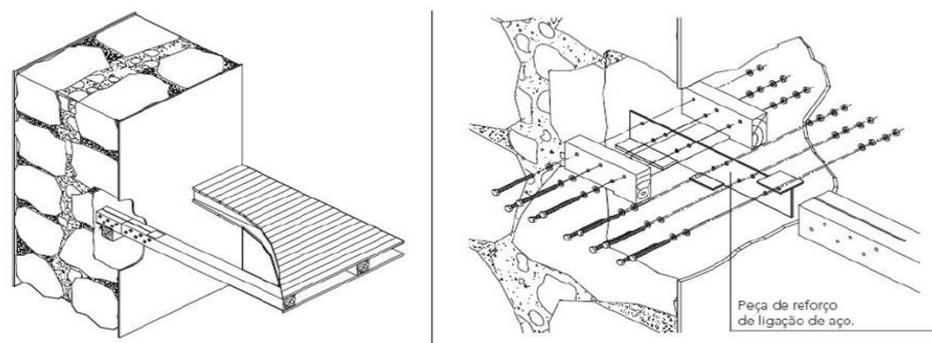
Reforço de apoio através da introdução de elementos metálicos no interior da viga (Cóias, 2007)
